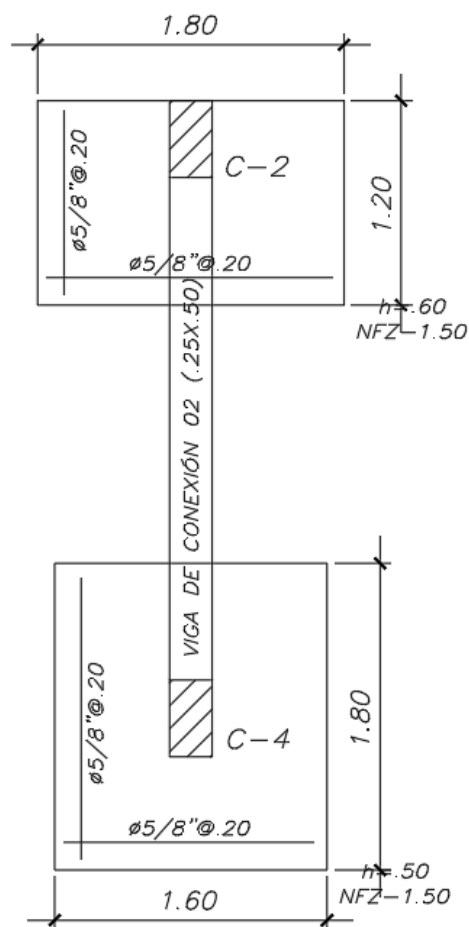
Diseño de zapatas conectadas para las columnas C-2 y C-4
